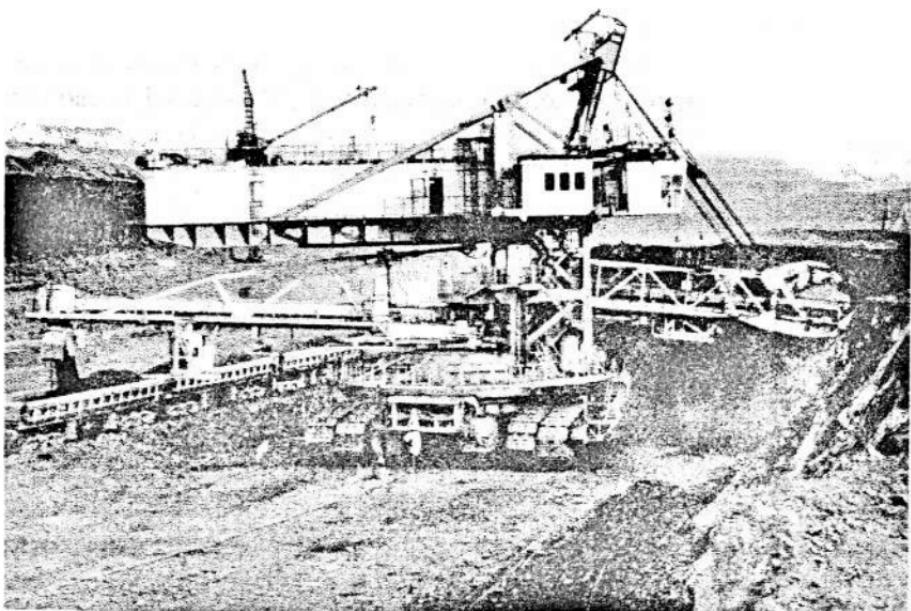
Роторный экскаватор ЭРП-1250. Опытный образец
